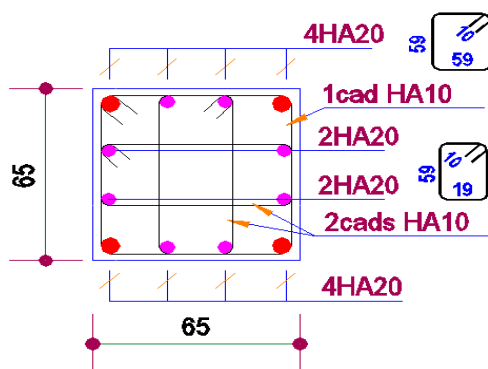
Schéma de ferrailage des poteaux du S. Sol, RDC, 1^{er} étage
